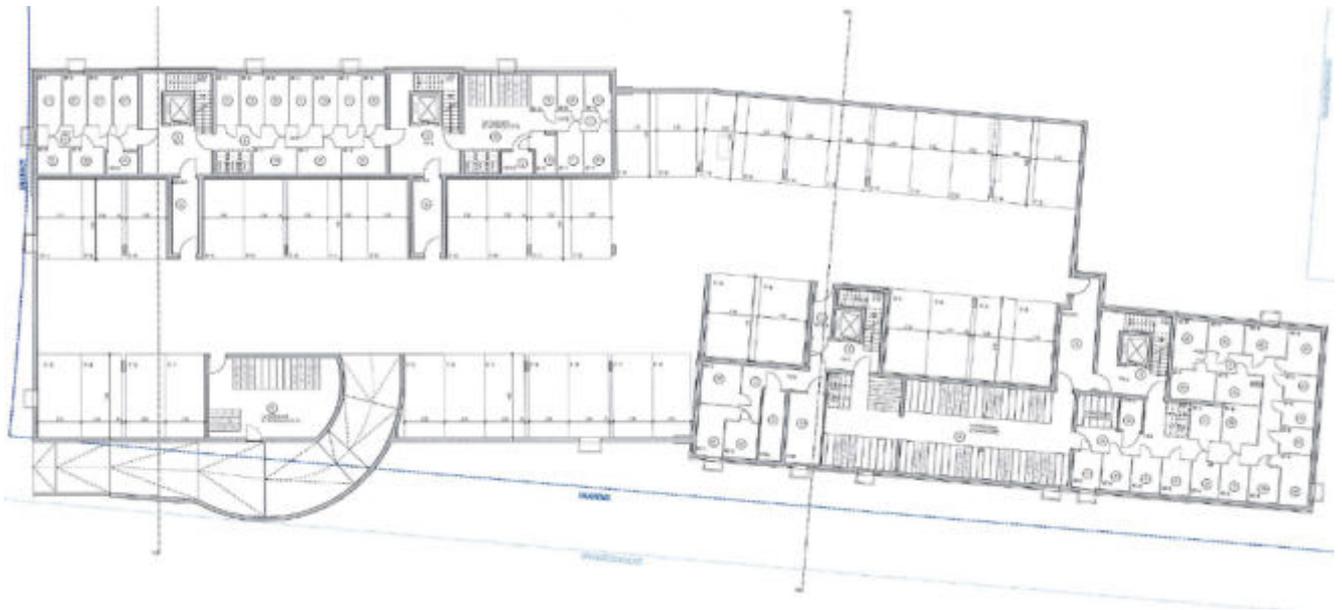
Grundriss UG/Tiefgarage (ohne Maßstab); Quelle: Anlage 1 zur Urkunde 303/2021/ Teilungserklärung vom 10.02.2021, Roteintragung - Lage von Kellerraum Nr. 16 - durch den SV
